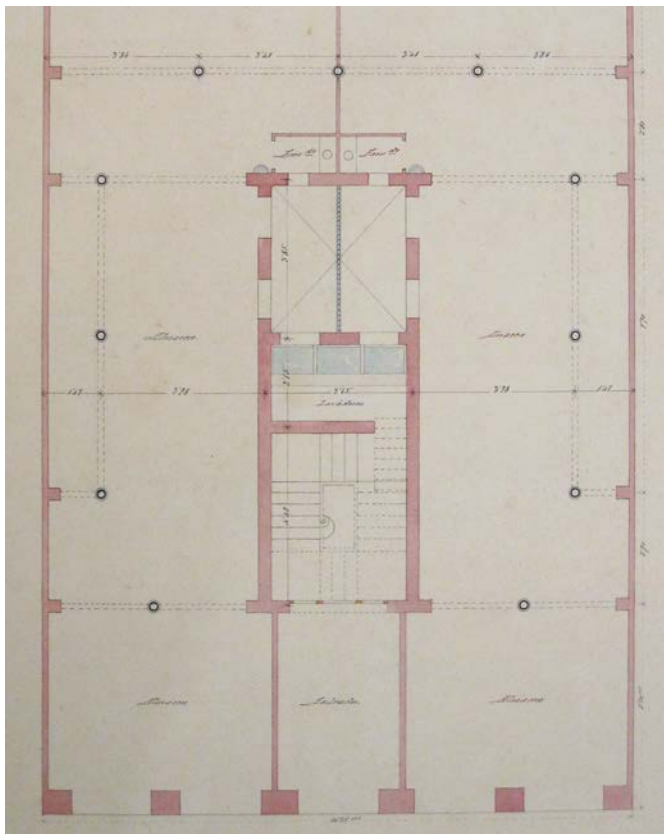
Plànol de planta baixa (casa Romà Macaya, arquitectes Bassegoda, 1892). Font: AHCOAC H115B/3/81.
